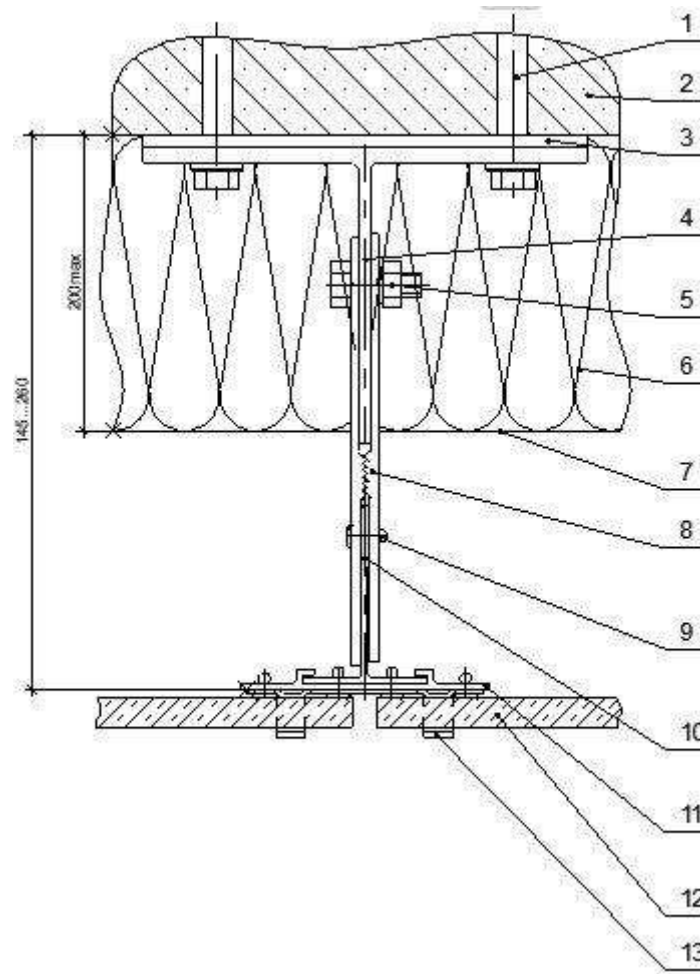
Кріплення облицювальних плит за допомогою клямерів
